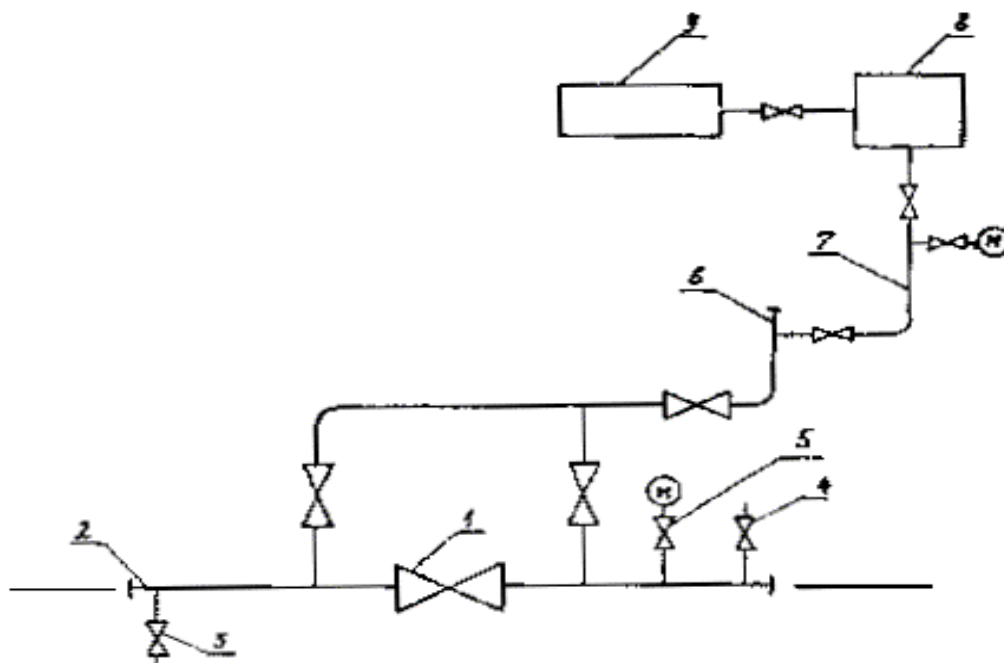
Принципиальная схема предварительного гидравлического испытания кранового узла
